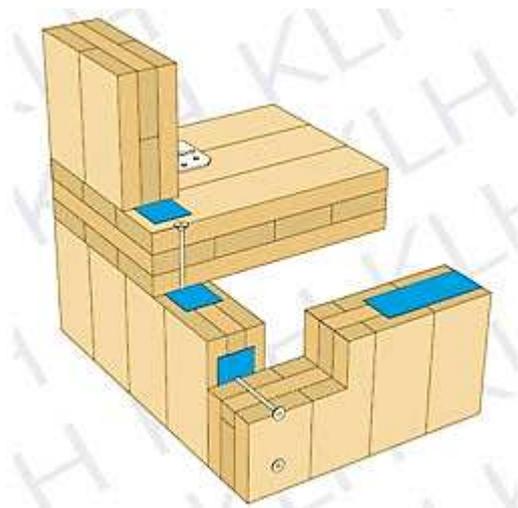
Encontro típico entre parede-piso-parede com estrutura de painéis CLT [24]
